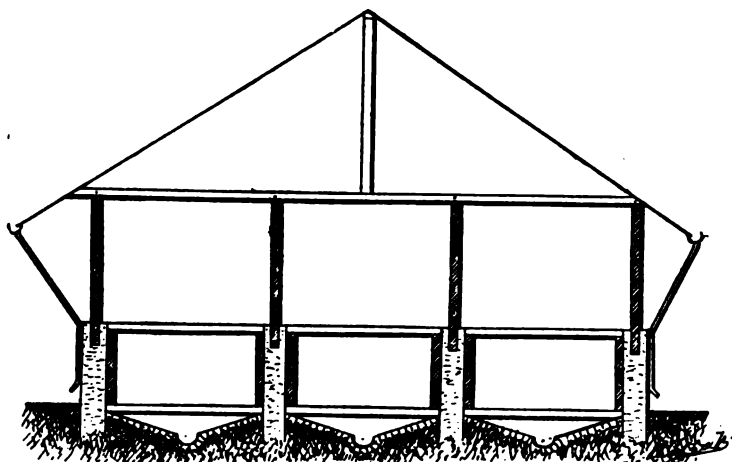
COUPE TRANSVERSALE DE LA CASE A FERMENTER
